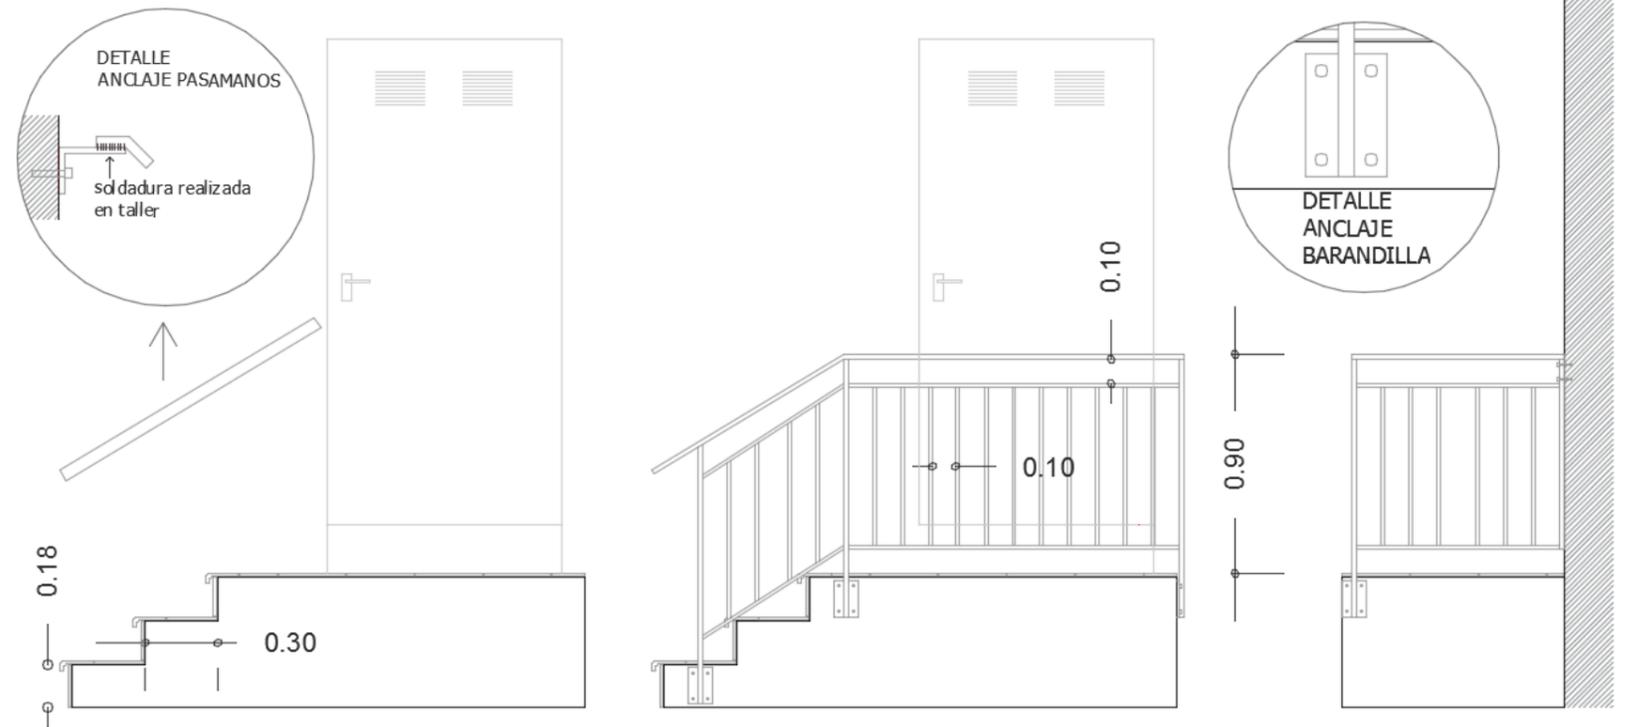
Detalle barandilla. 2018. Elaboración propia
